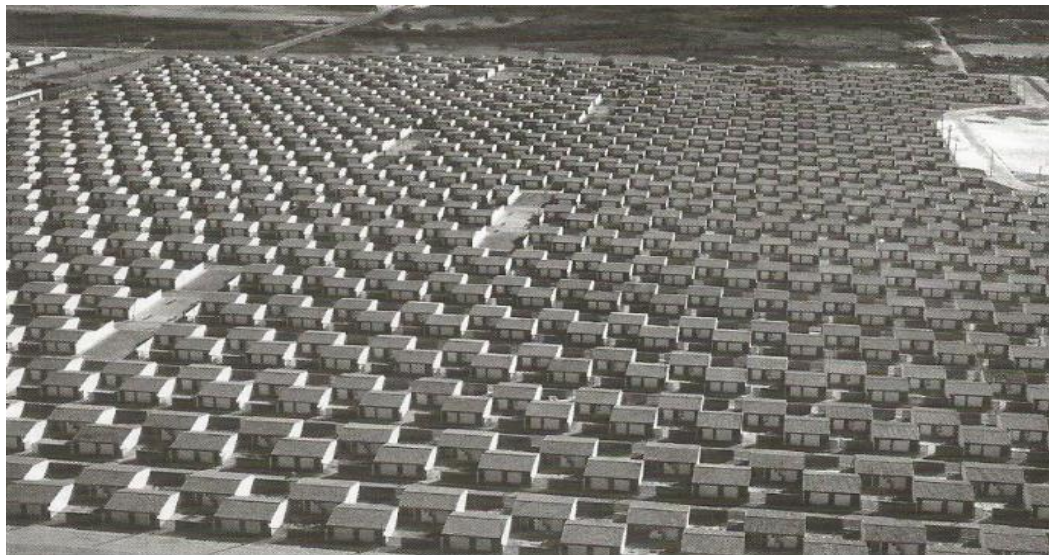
Foto conjunto habitacional construído pelo BNH.
